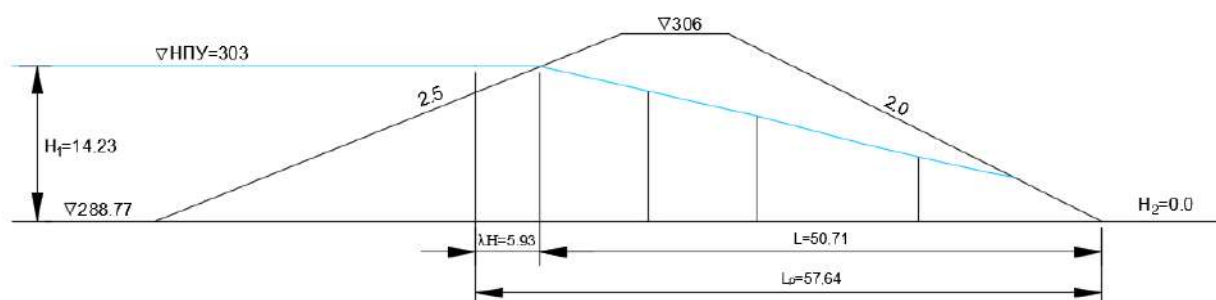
Расчётная схема грунтовой плотины без бермы.
